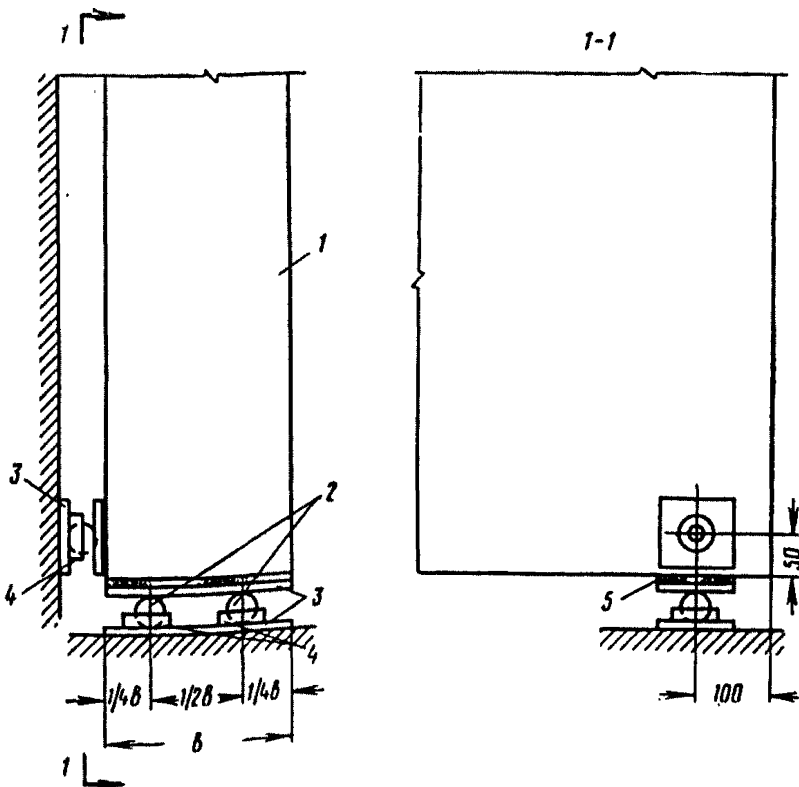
Конструкция опор панели при испытании ее на изгиб
